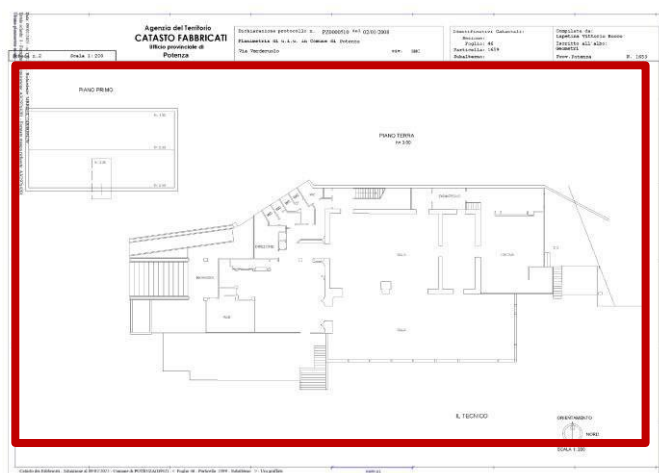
Planimetria Catastale Lotto Lu – Piano Terra e Sottotetto (ALL. 06).
